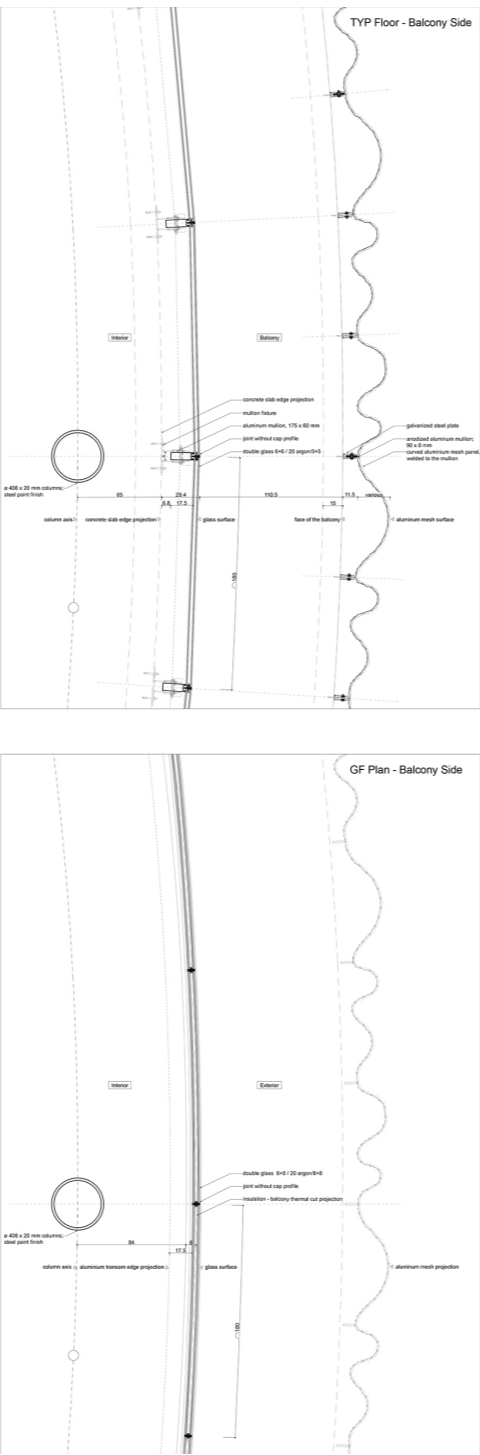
Detalles constructivos en planta de la planta primera (superior) y planta baja (inferior). Observamos la diferencia en el detalle de carpinterías del cerramiento de vidrio.
